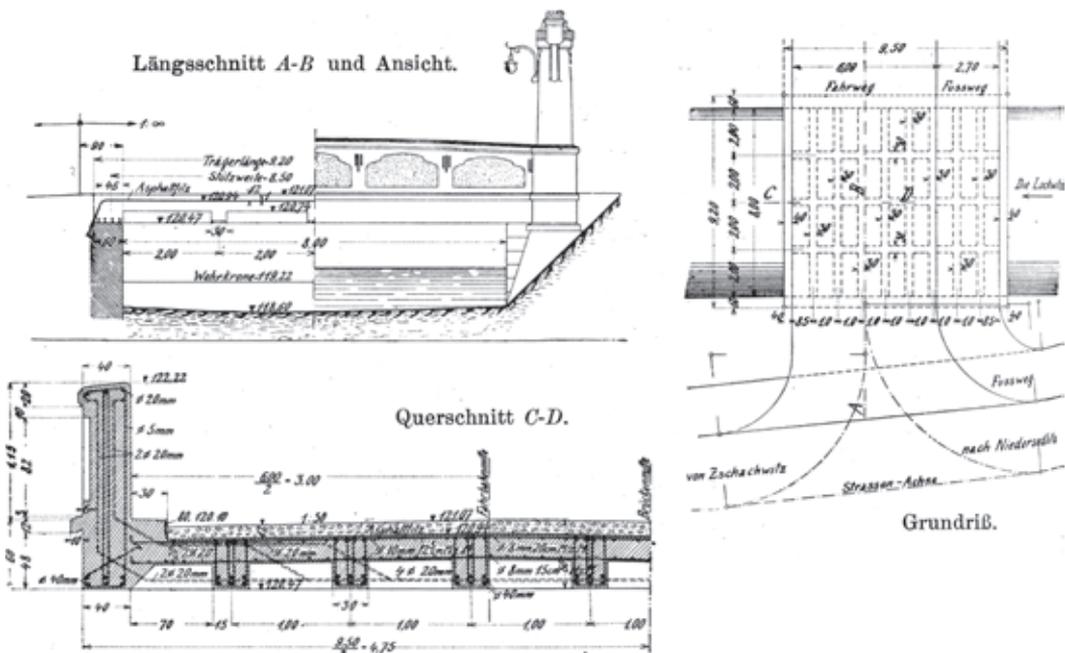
Brücke über den Lockwitzbach in Niedersiedlitz, heute Dresden, Entwurf Willy Gehler, Ausführung Max Pommer, Grundriss, Schnitte und Ansicht, 1904/05 | Zeichnungen: [6, S. 276]
